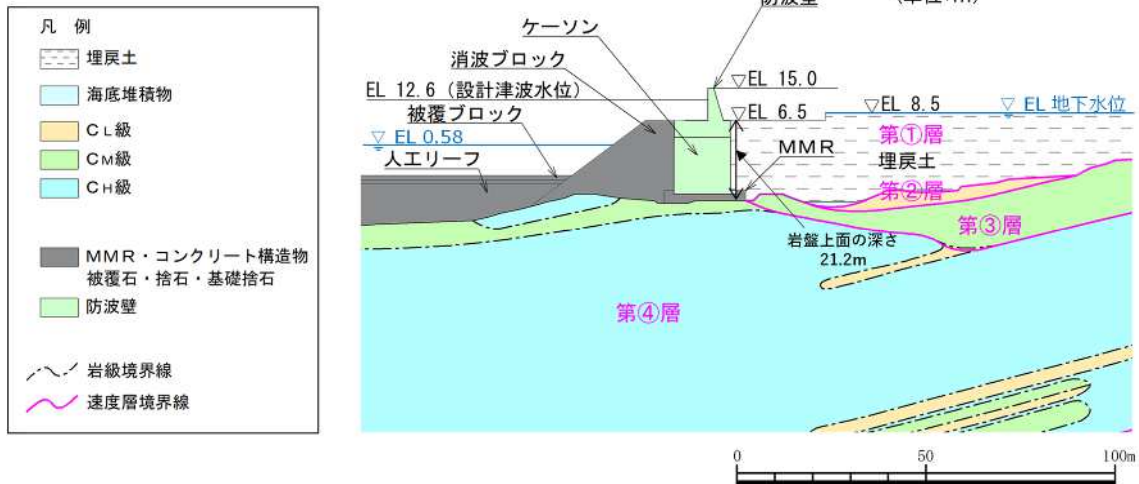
防波壁（波返重力擁壁）の横断面図
